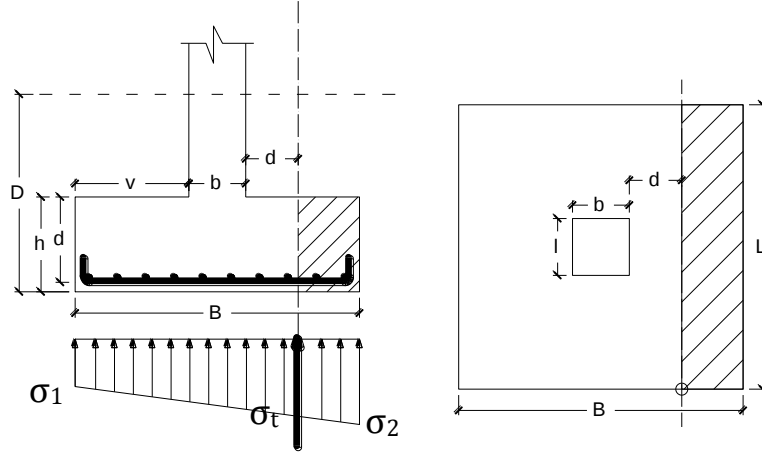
Cálculo a Corte en zapatas aisladas flexible
